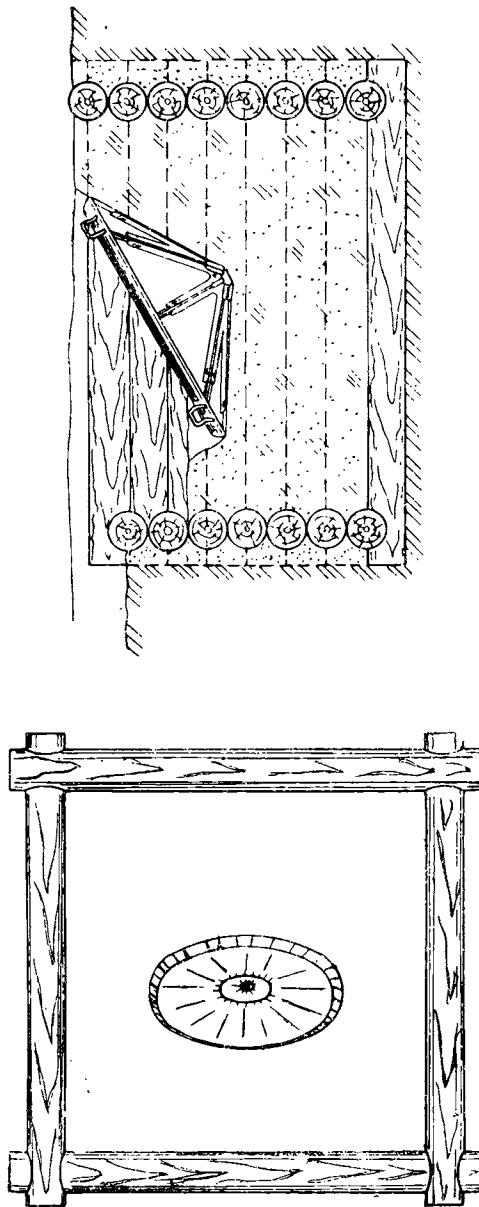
Укрепление грунта под опорную плиту подкладкой матов из ветвей
